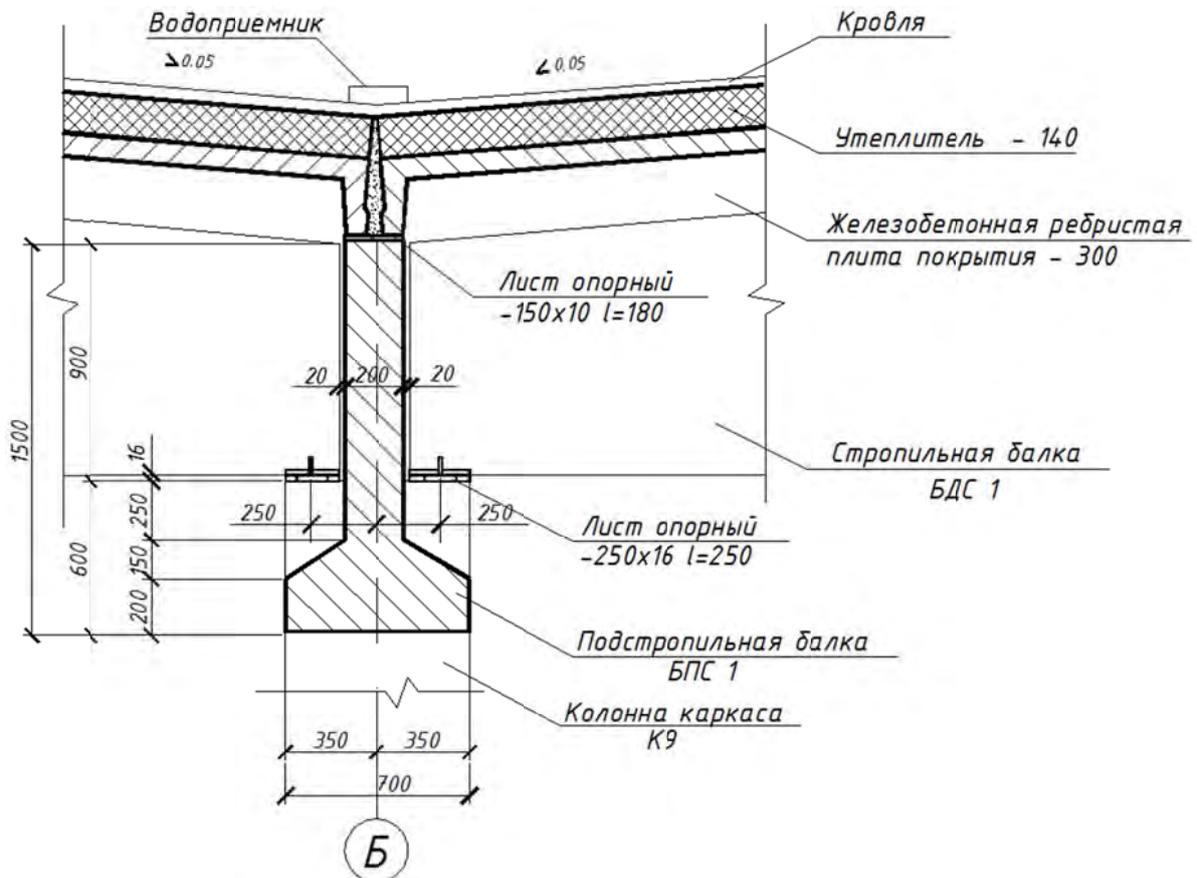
Узел сопряжения стропильных и подстропильных конструкций промышленного здания
